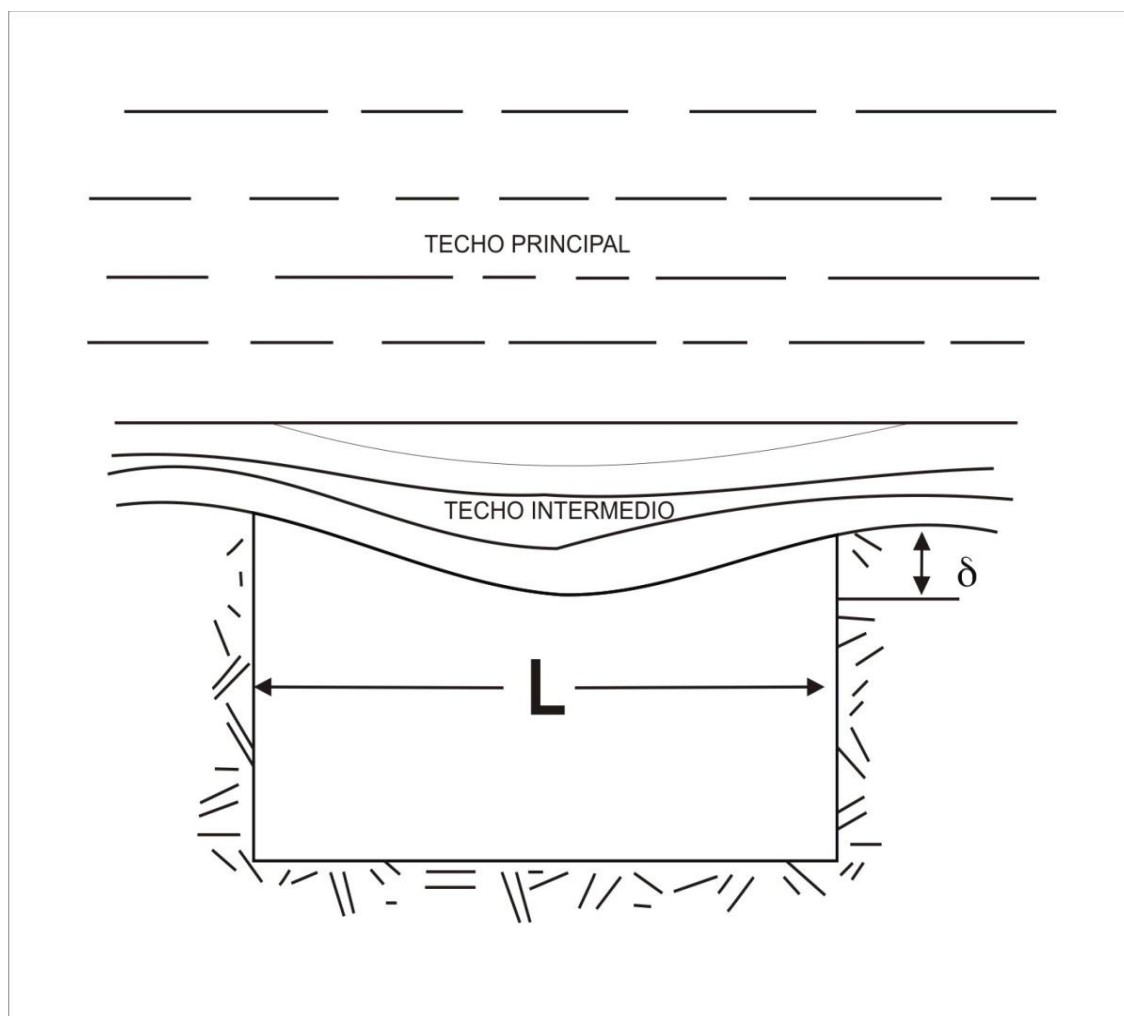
Aplicación modelo de viga elástica para el diseño de cámaras
